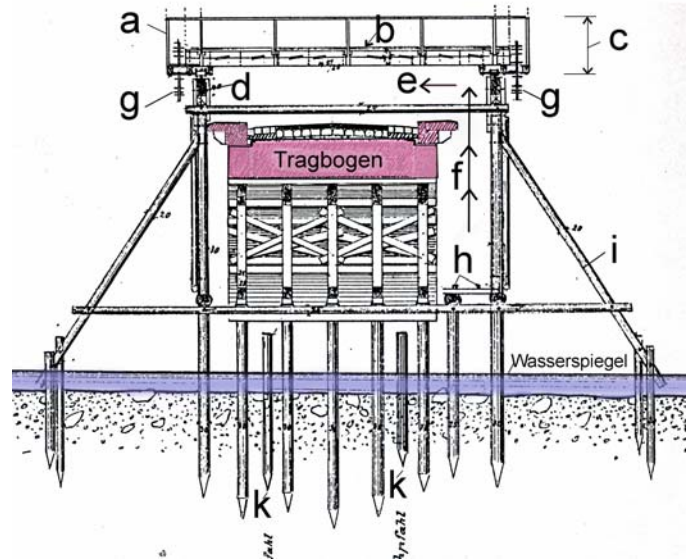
Brückenquerschnitt mit Gerüst für die Brückenschalung und das Versetzgerüst mit dem Steinversetzwagen vgl. Bild 12.
